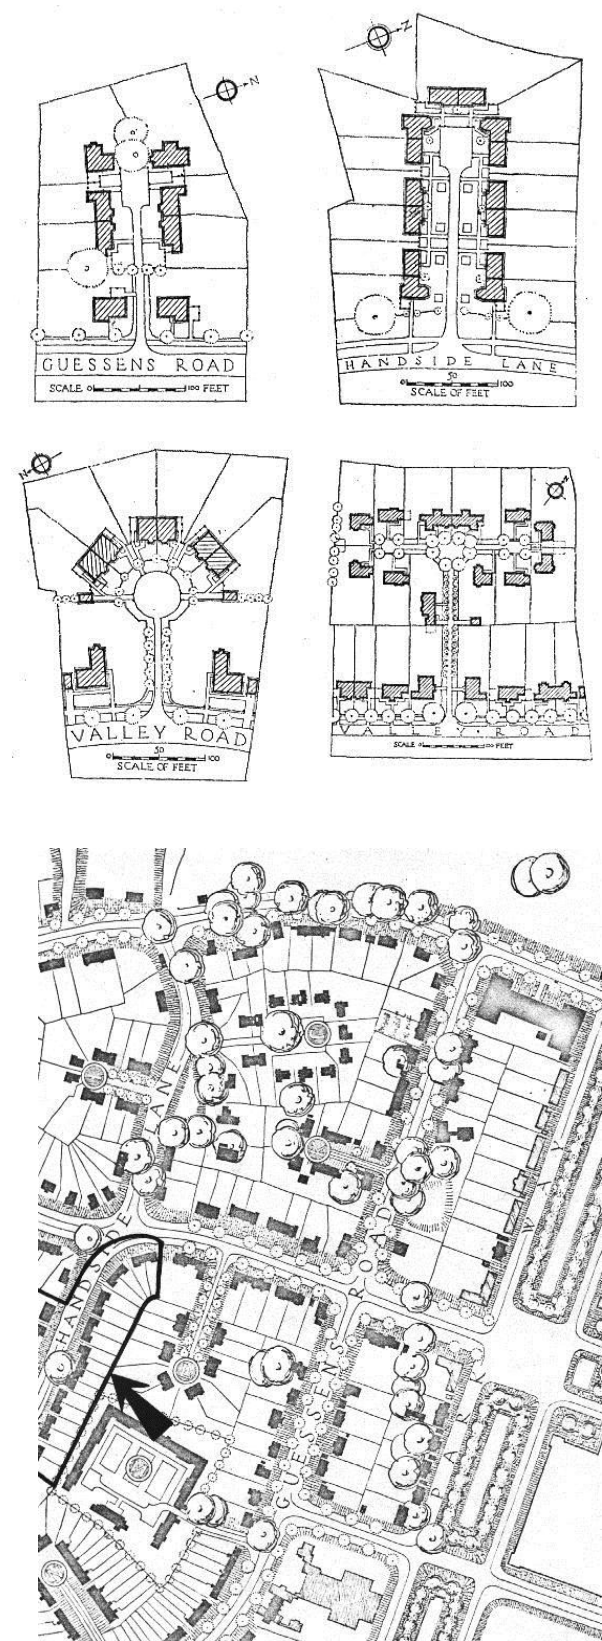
Cul-de-sac en Welwyn Garden City. Fuente: rickmansworthherts.freerve.co.uk
